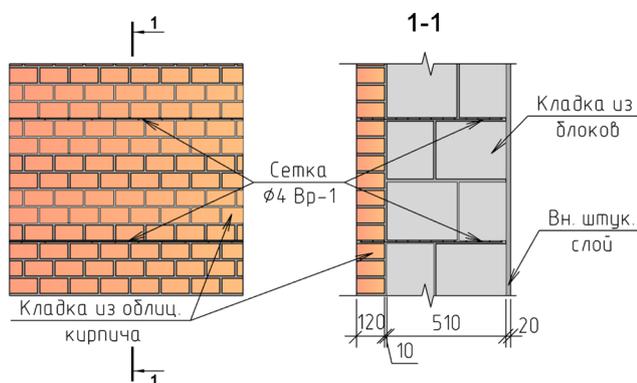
Схема армирования фрагмента ограждающей конструкции
